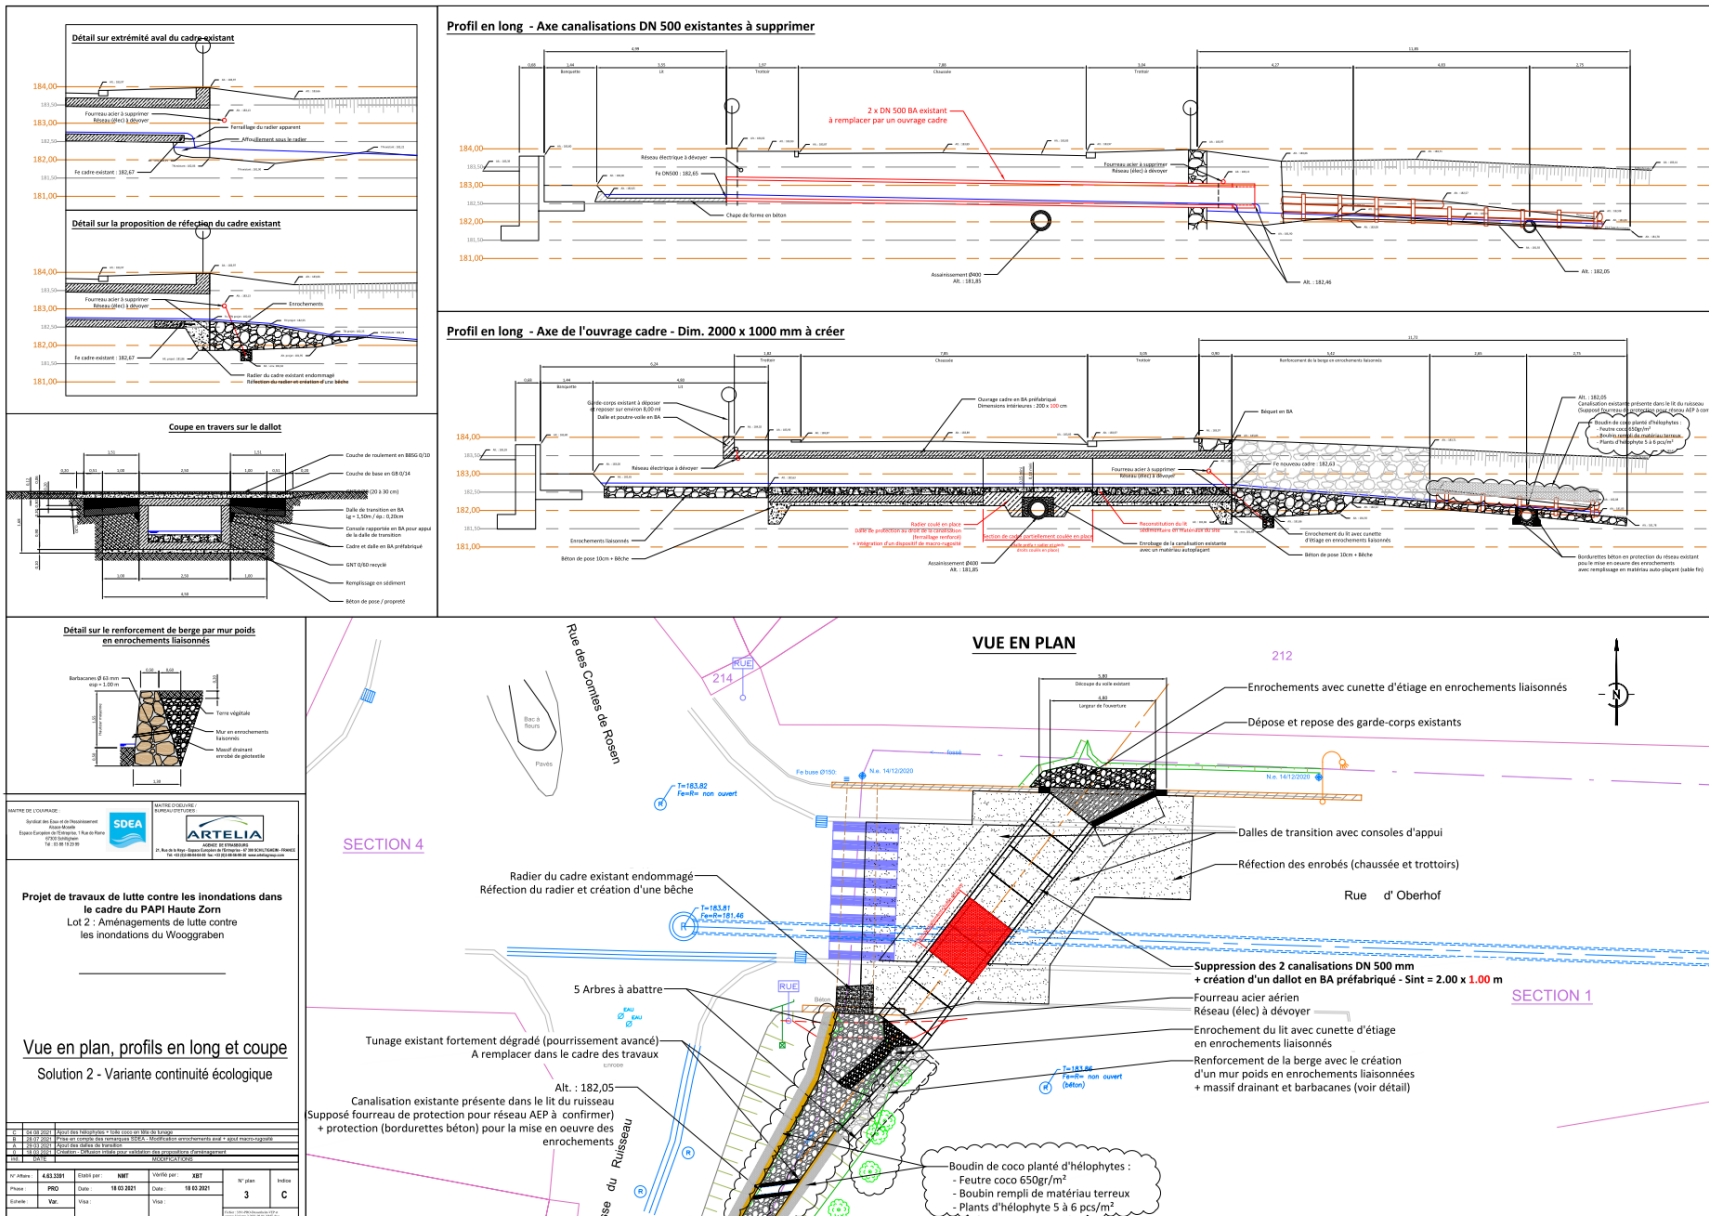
Vue en plan et en coupe de la reprise de l'ouvrage de franchissement du Wooggraben sous la RD133 (ARTELIA, 2021)
